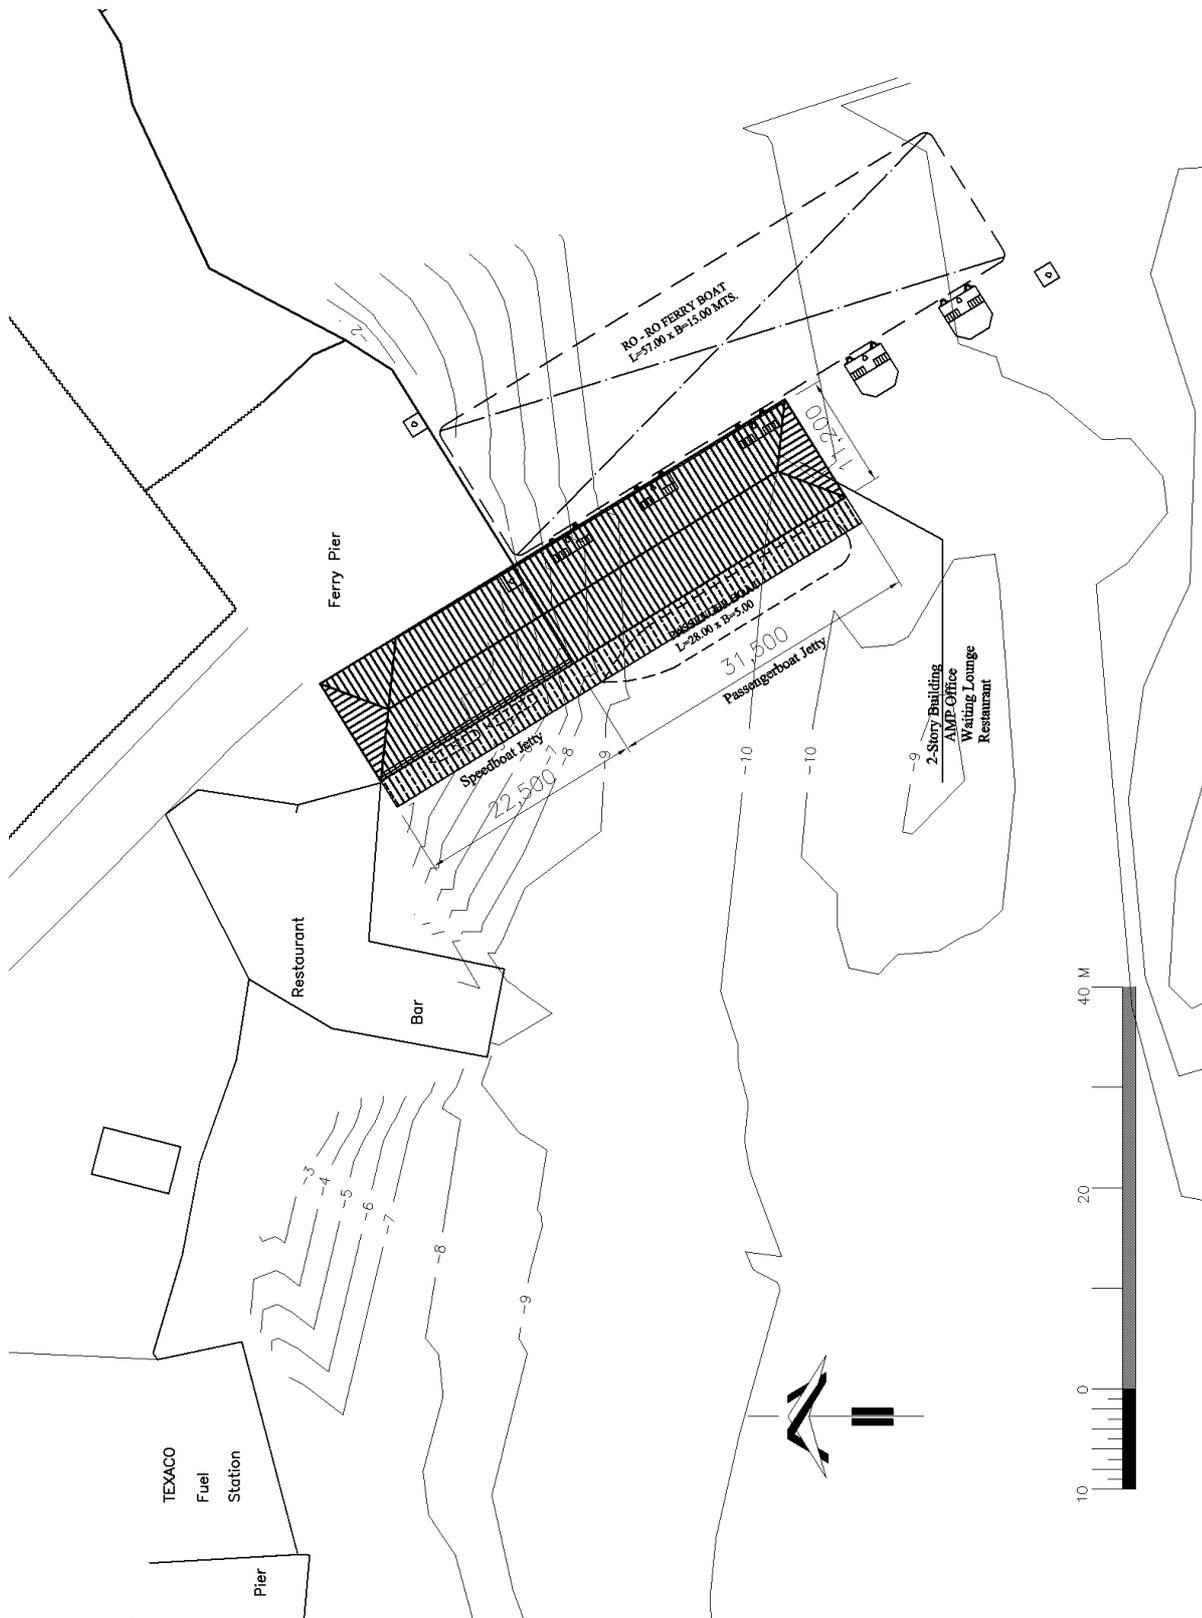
(2) Disposición del Plan del Puerto de Almirante
